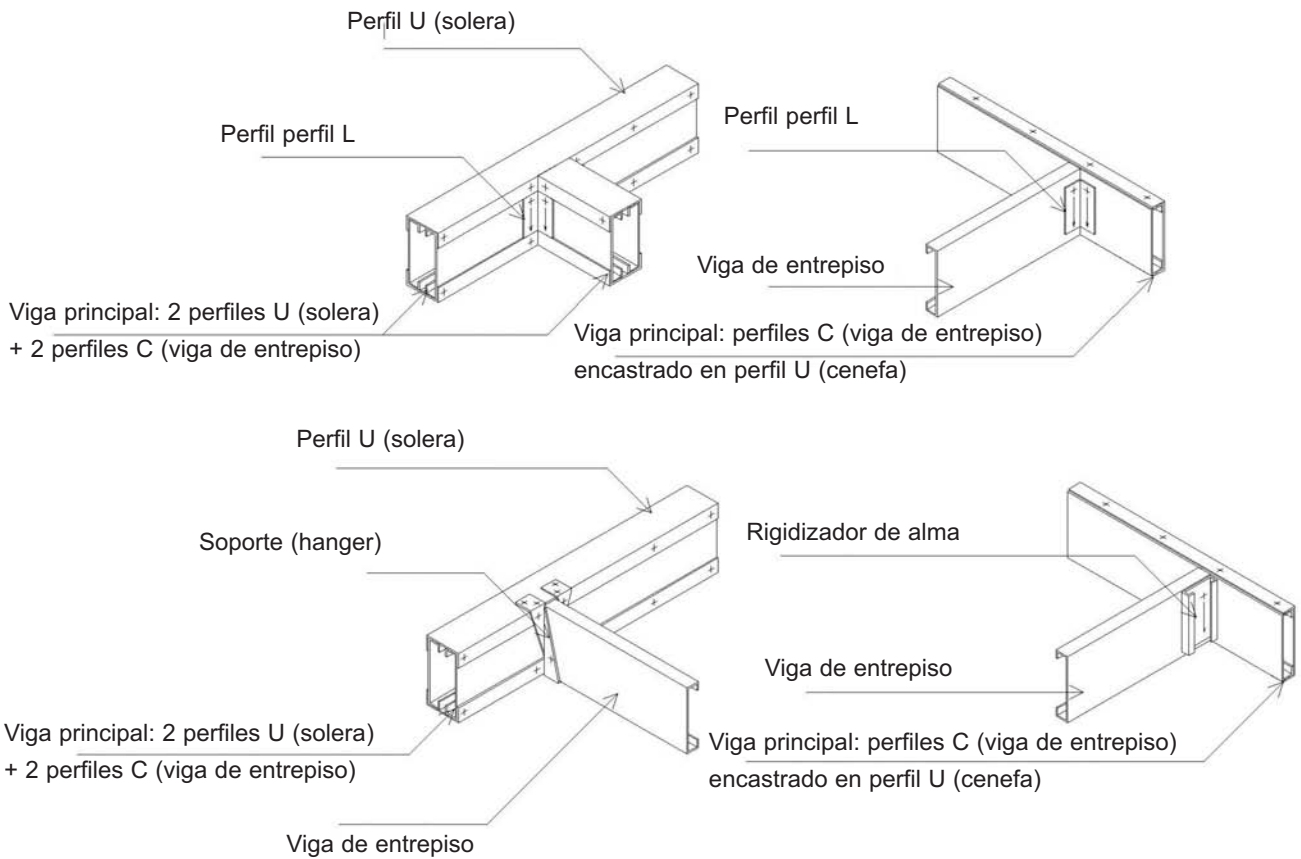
Tipos de vigas principales para el apoyo de viguetas de entrepiso.
